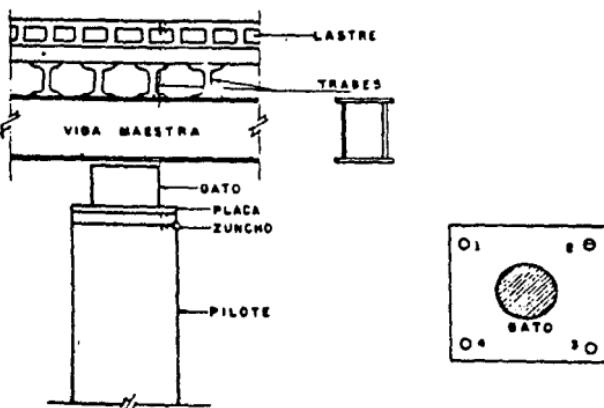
Zona en planta para pruebas de carga con pilotes electromecánicas
